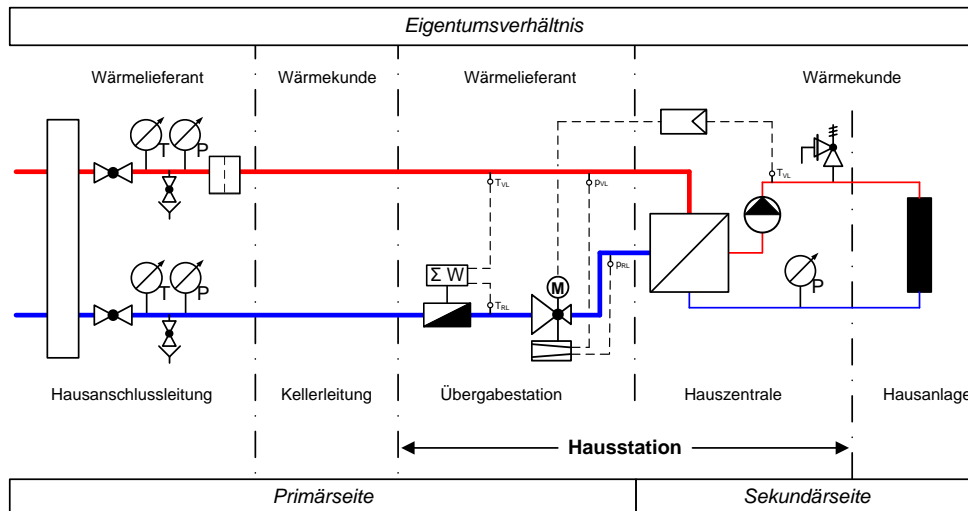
Hausanschluss mit indirekter Wärmeübergabe. Für kleine Leistungen wird die Hausstation oft als modulare Einheit ausgeführt, was als Kompaktstation bezeichnet wird.
